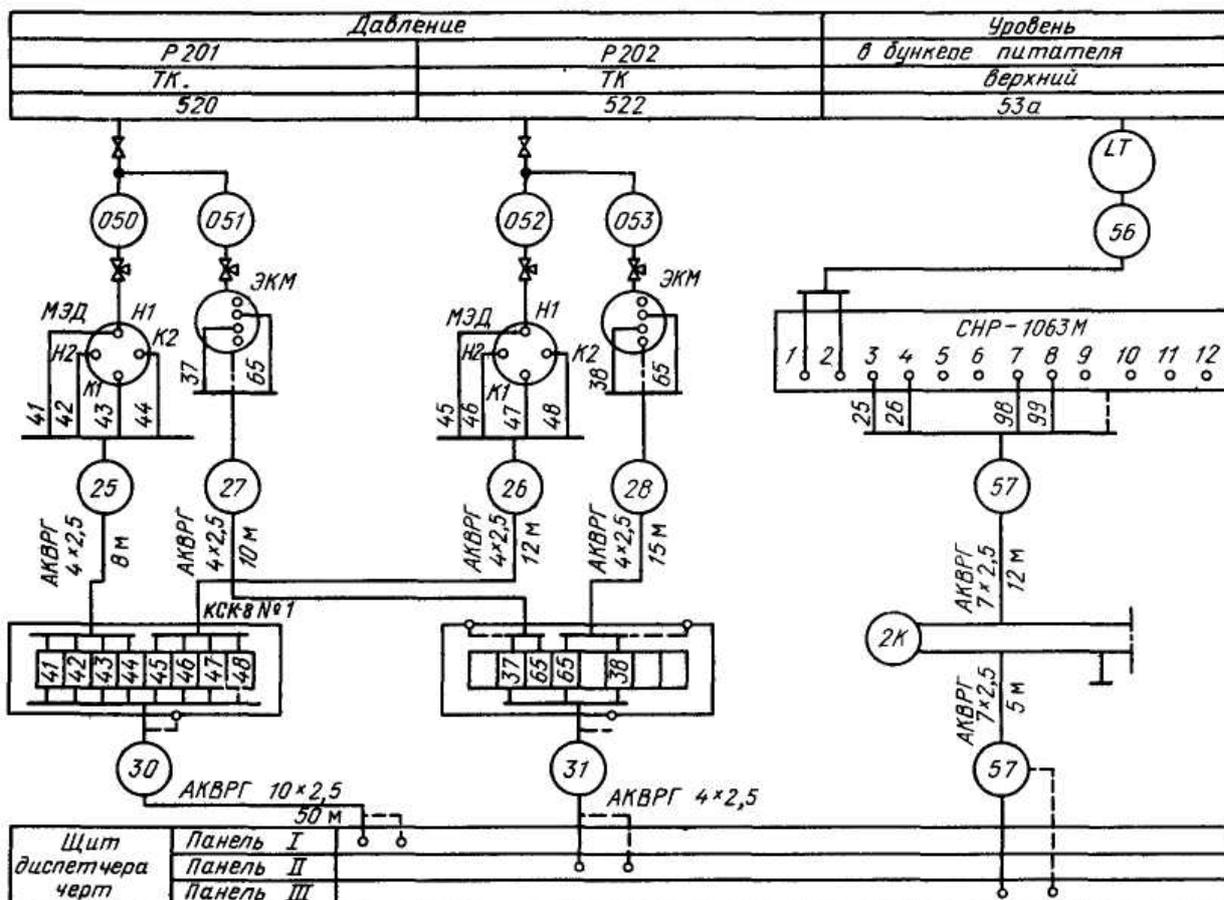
Фрагмент схемы внешних соединений электрических проводок [1]
